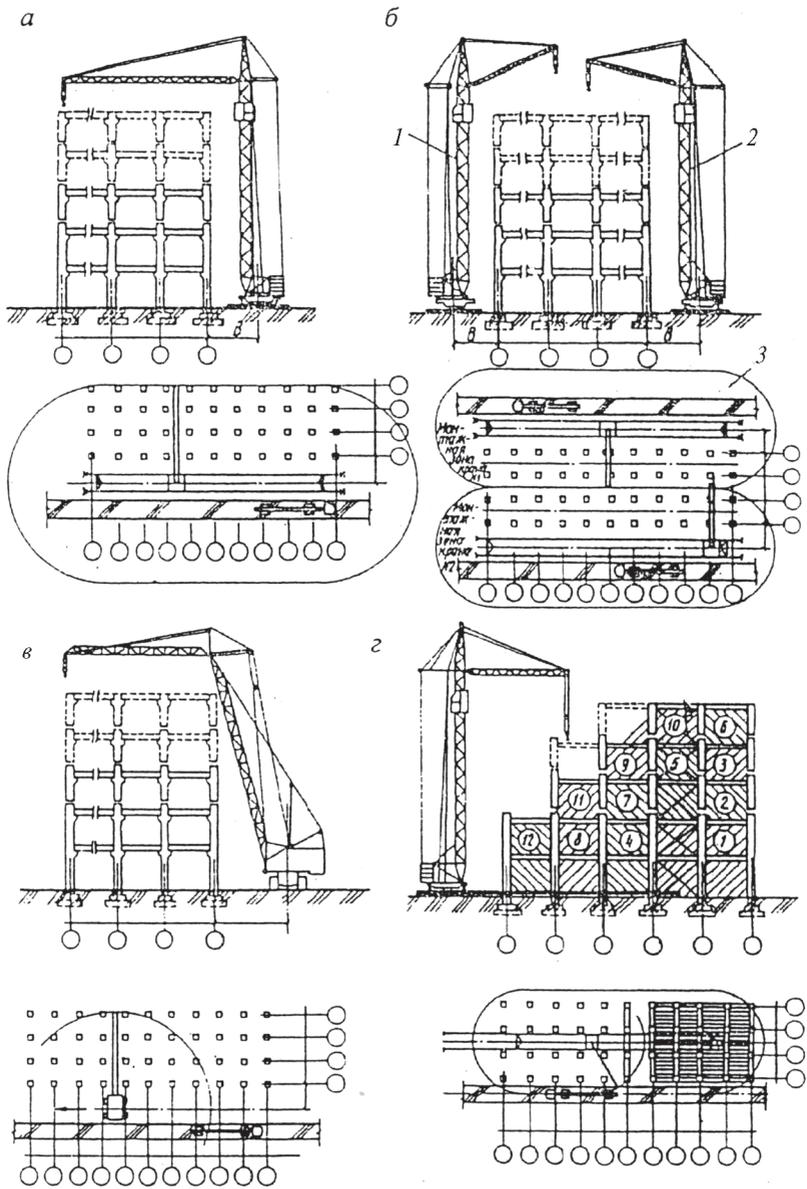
Варианты расположения монтажных кранов при возведении многоэтажных каркасно-панельных зданий: (см. стр. 13)
